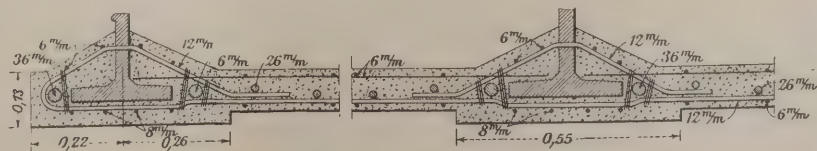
Einzelheiten der unteren Eisenbetondecke.
